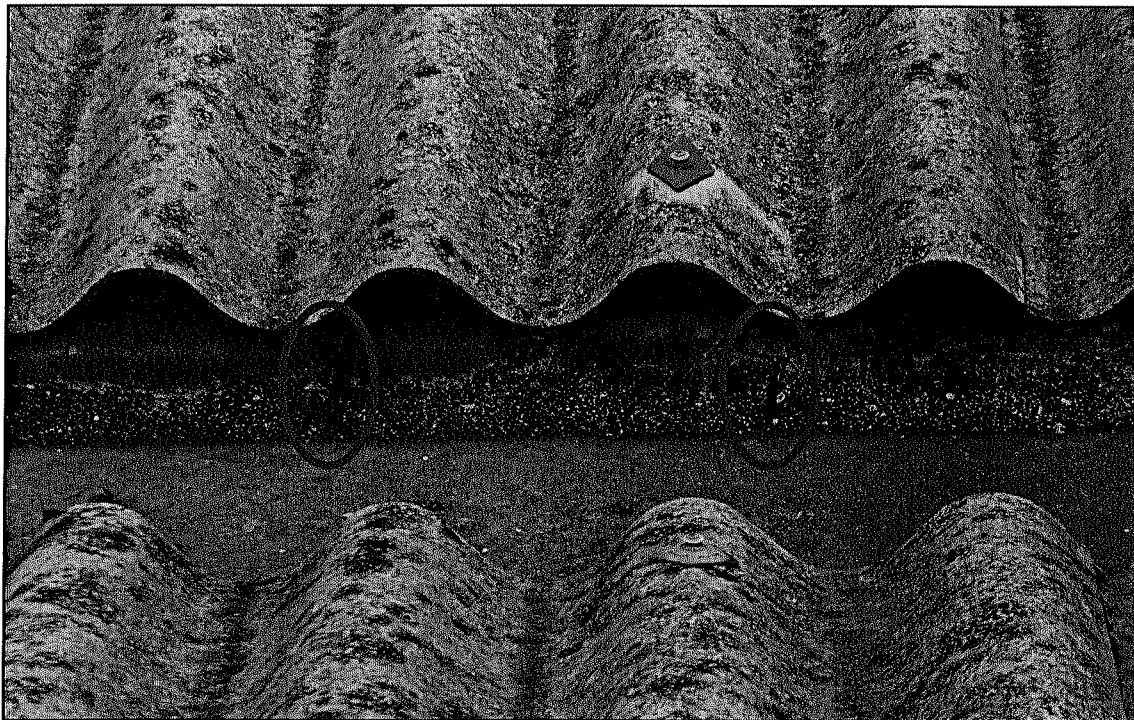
Esposizione alle intemperie delle armature metalliche degli estradossi delle travi del tetto che presentano iniziali tracce di corrosione.
